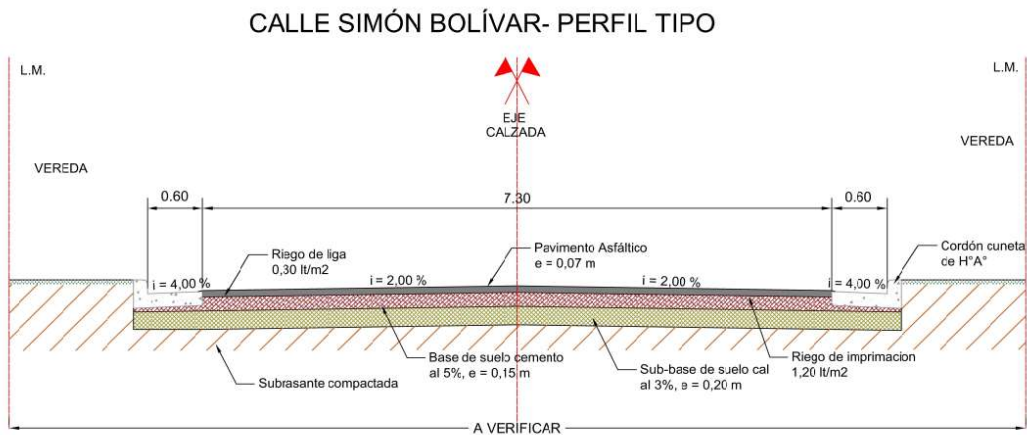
Sección transversal tipo de la calle Simón Bolívar.
